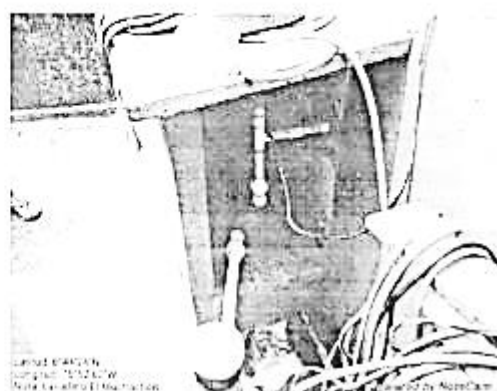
Vista de las instalaciones del Lavadero Lavamotos El Muchachón
